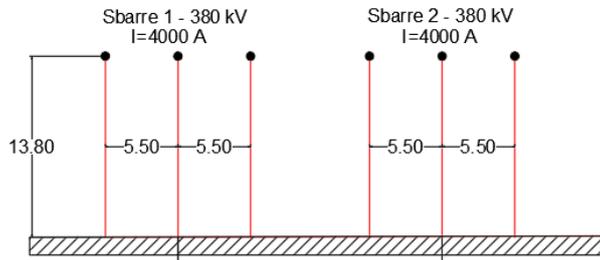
Sezione di calcolo A-A riportata in planimetria
